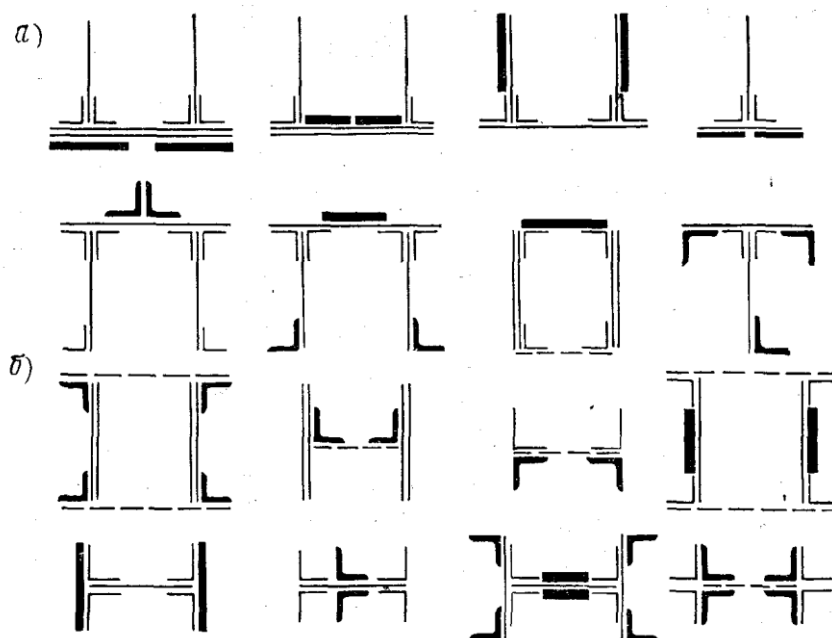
Схемы усиления сечений элементов сквозных ферм: а – поясов; б – раскосов, стоек и подвесок
